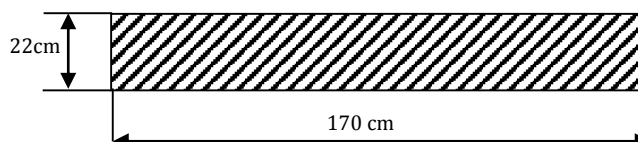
Coupe transversale de la poutre intermédiaire.
